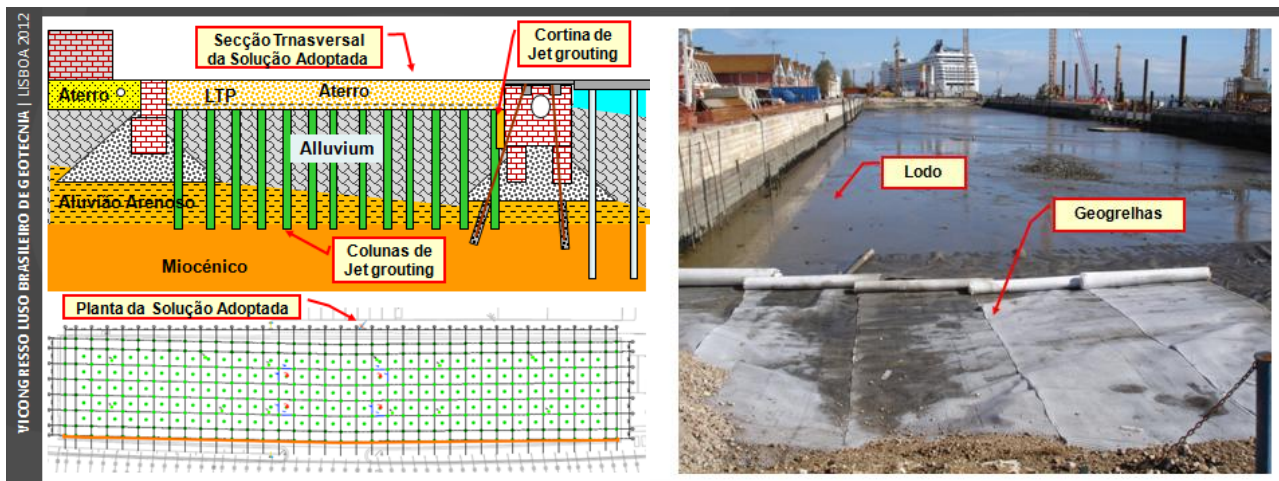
Planta, Corte Transversal Tipo e fotografia da Solução Executada
